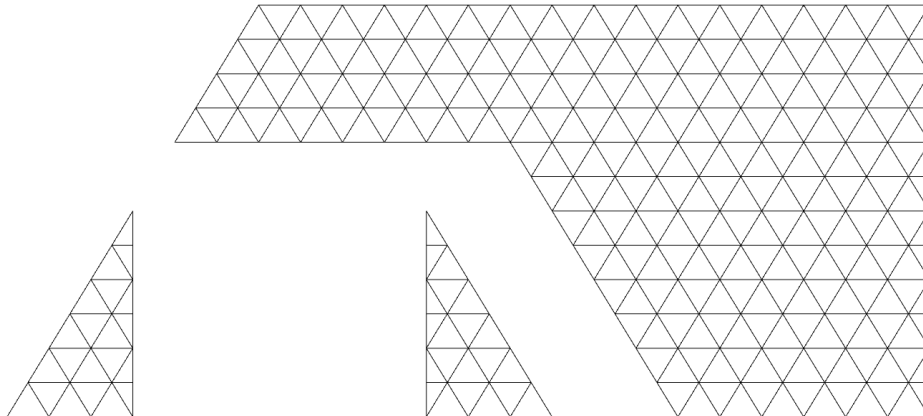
Estructura Paneles de Vidrio, Malla 3, Muro Acristalado, Fase 1
